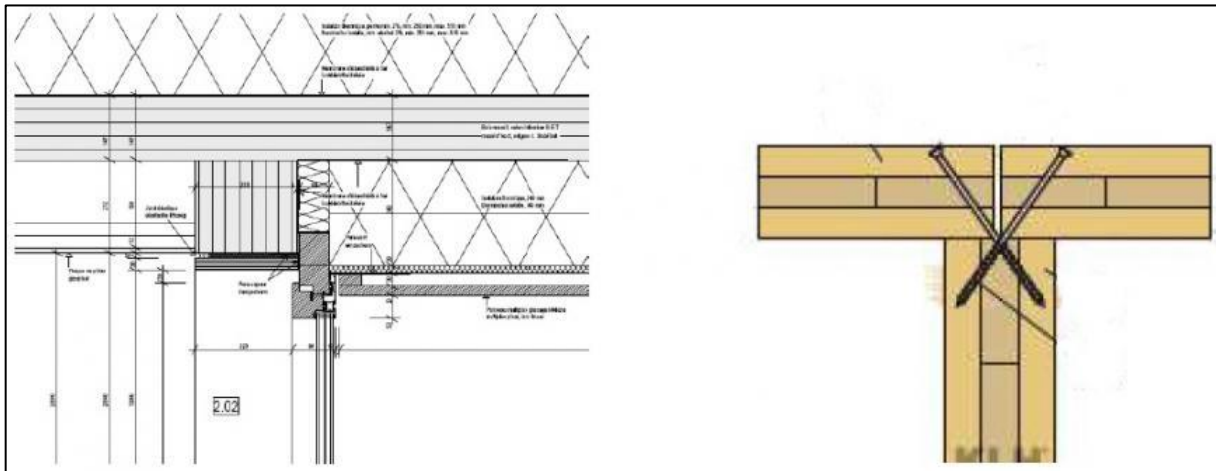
Jonction plancher – mur (source : [\*Préfabrication | Guide Bâtiment Durable \(guidebatimentdurable.brussels\)\*](http://Préfabrication | Guide Bâtiment Durable (guidebatimentdurable.brussels)))
